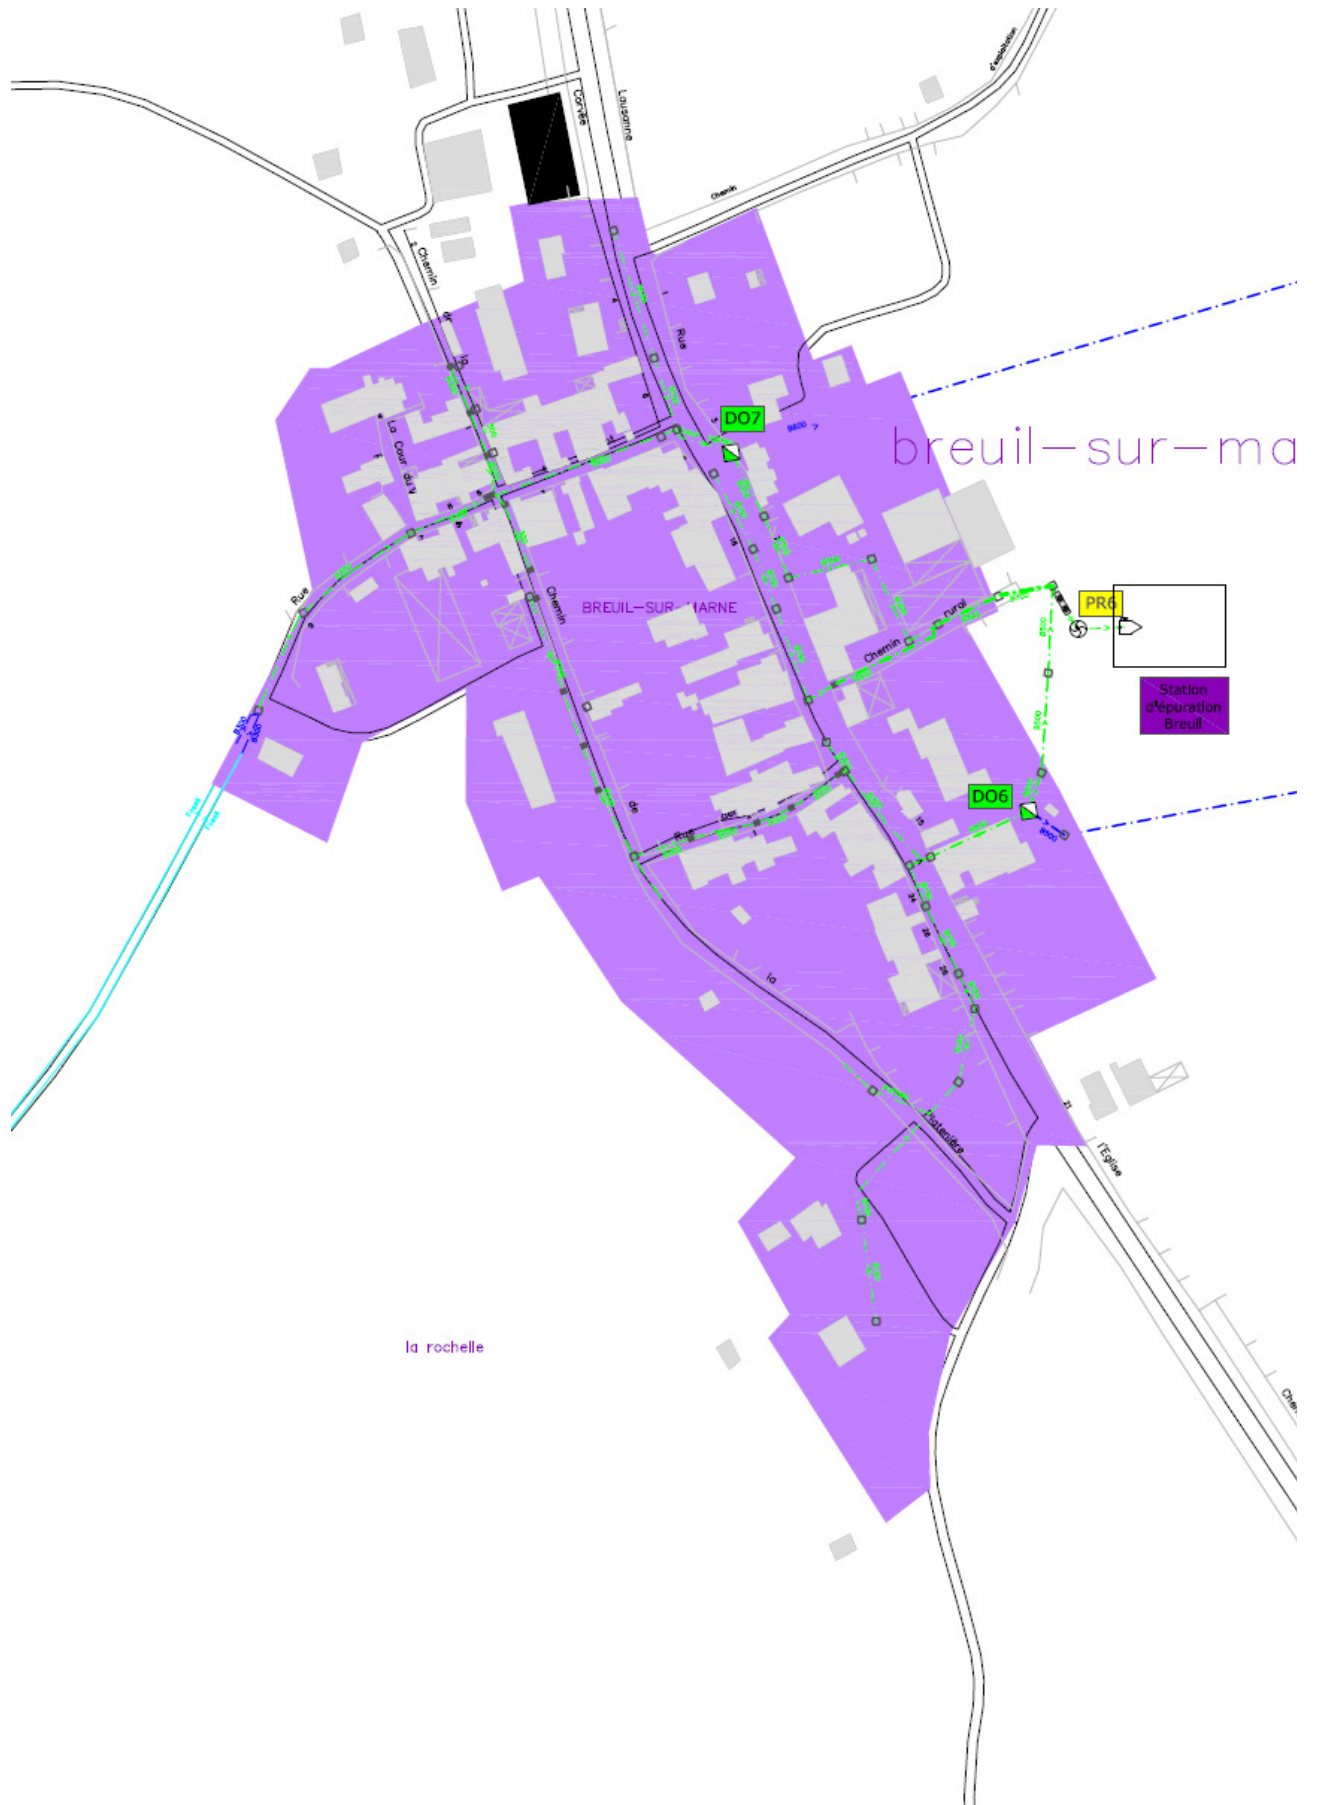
Zonage d'assainissement : Secteur Breuil sur Marne
